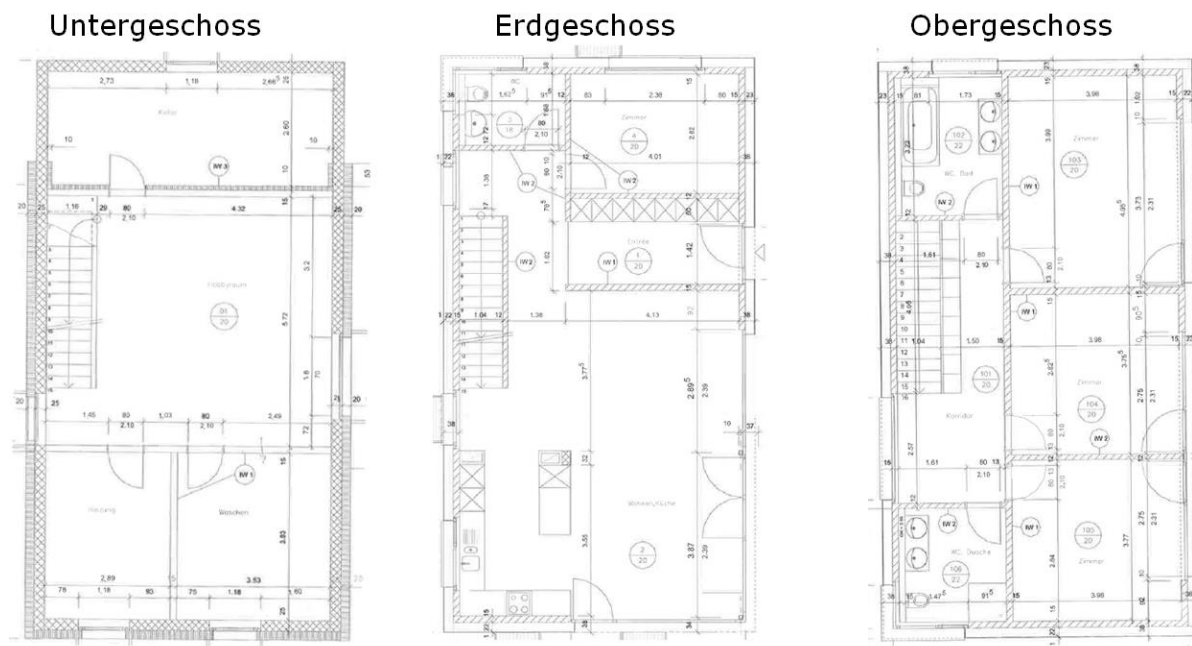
Grundrisse der Variante Neubau auf deren Basis die Gebäudesimulation erstellt wurde.
